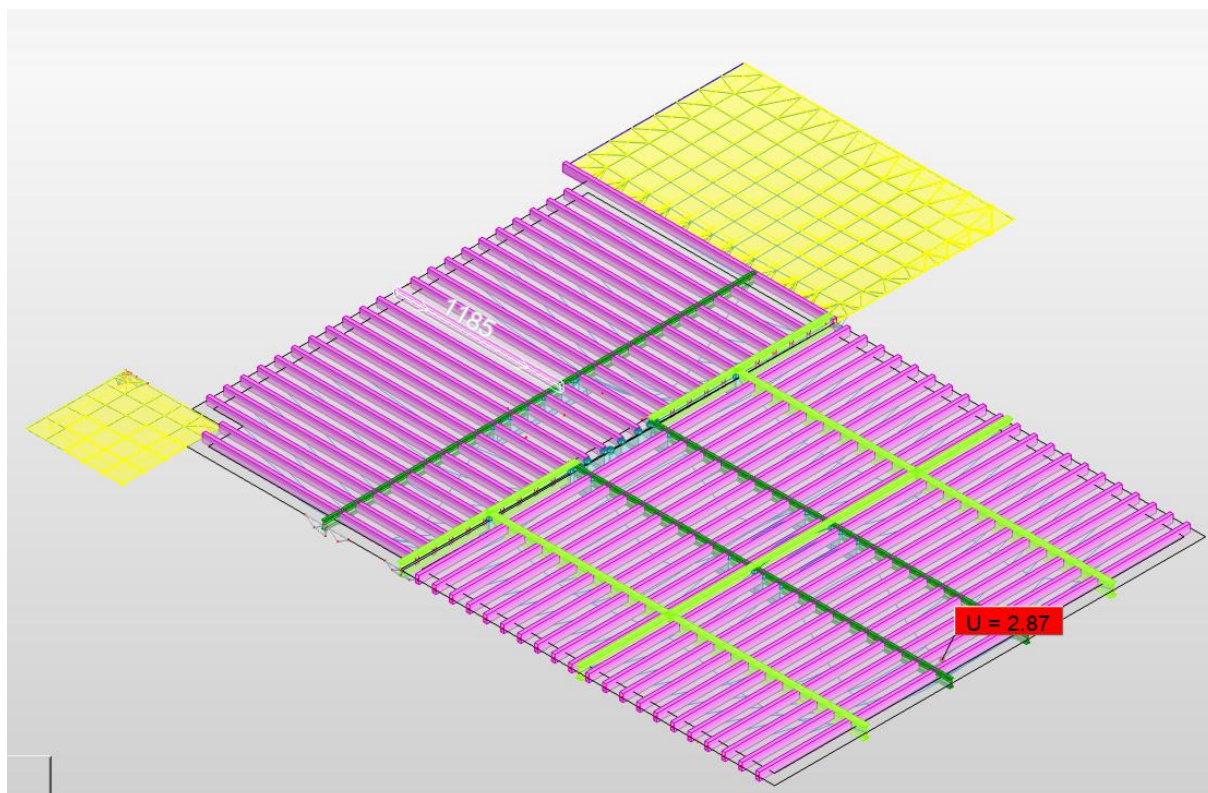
Deformação do pavimento após a adição de novas vigas metálicas
